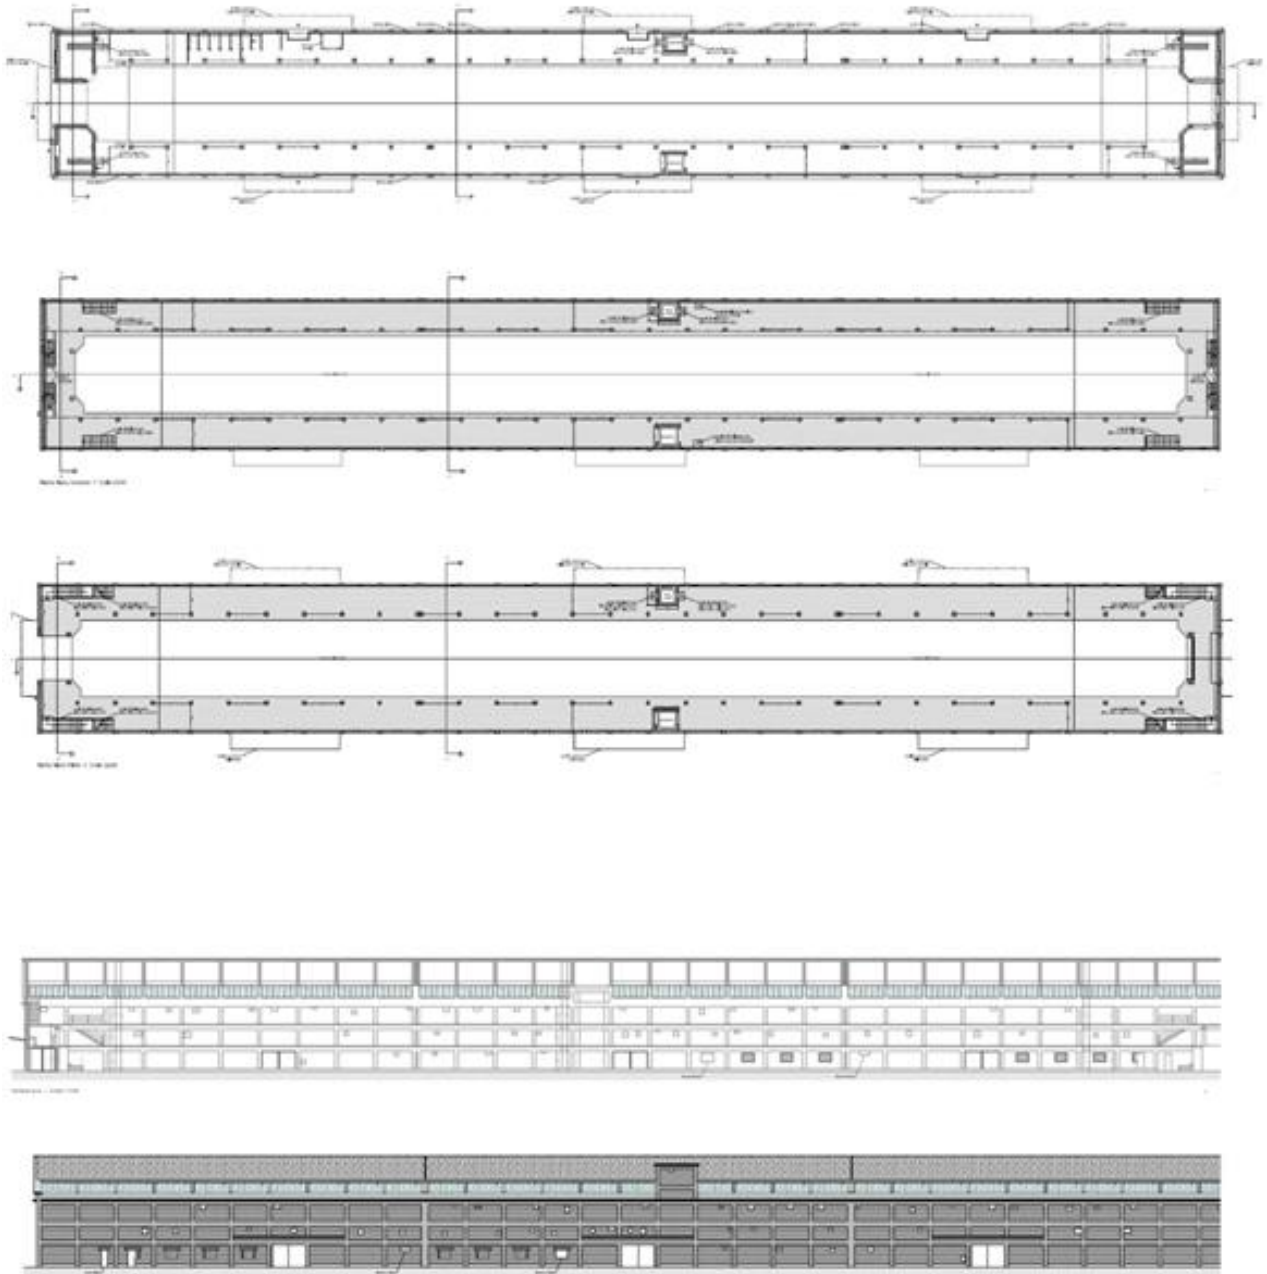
Pianta PT, P1, P2; Sezione; Prospetto
